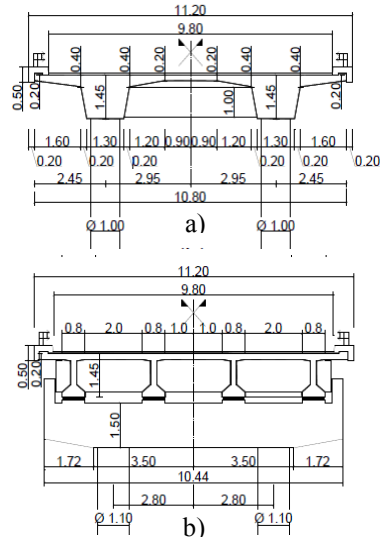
Sección transversal de los puentes: a) Gobernador del Campo b) Puente Ferrocarril Mitre
